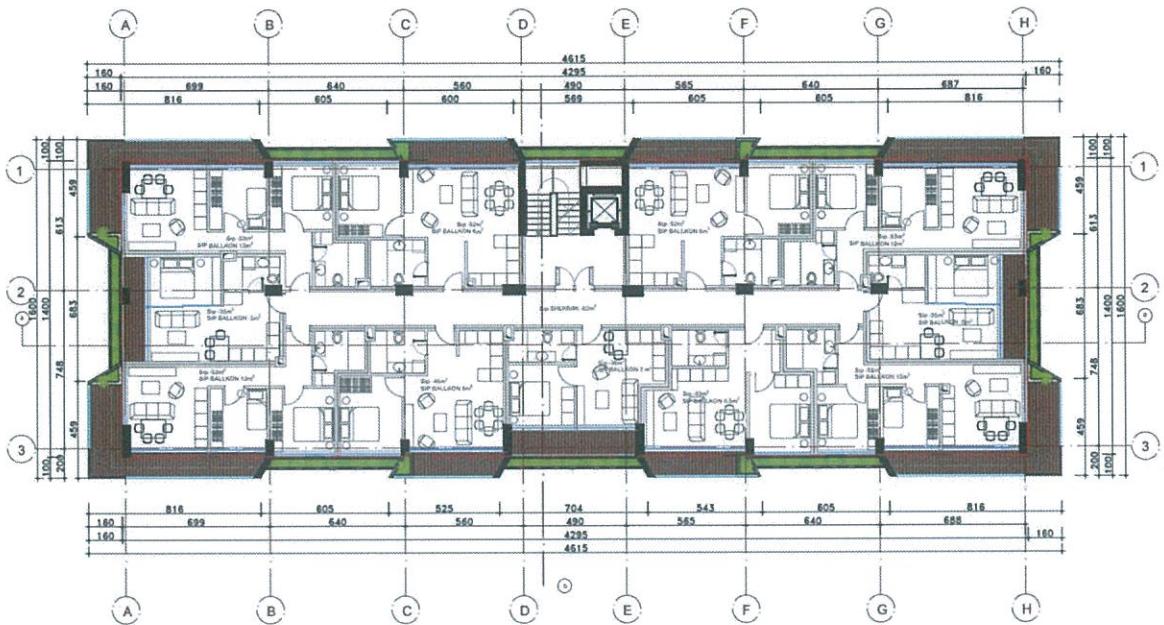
Planimetria e kosit tip sezioni 3 dhe 4
